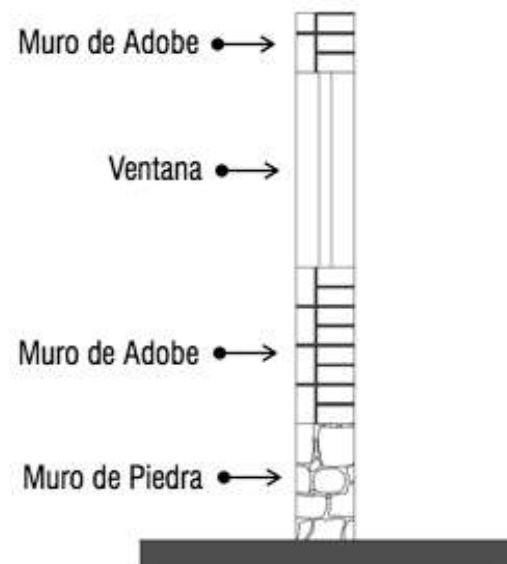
Muro de 30cm, compuesto de piedra v block de adobe
